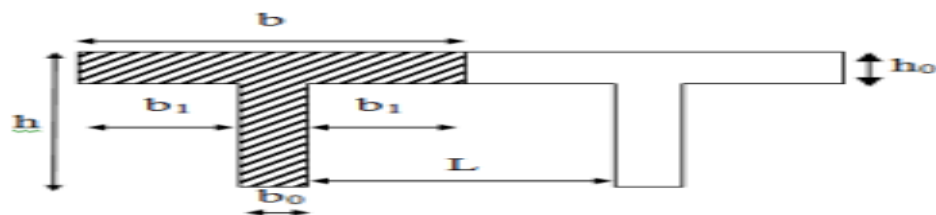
Coupe verticale sur un plancher en corps creux
